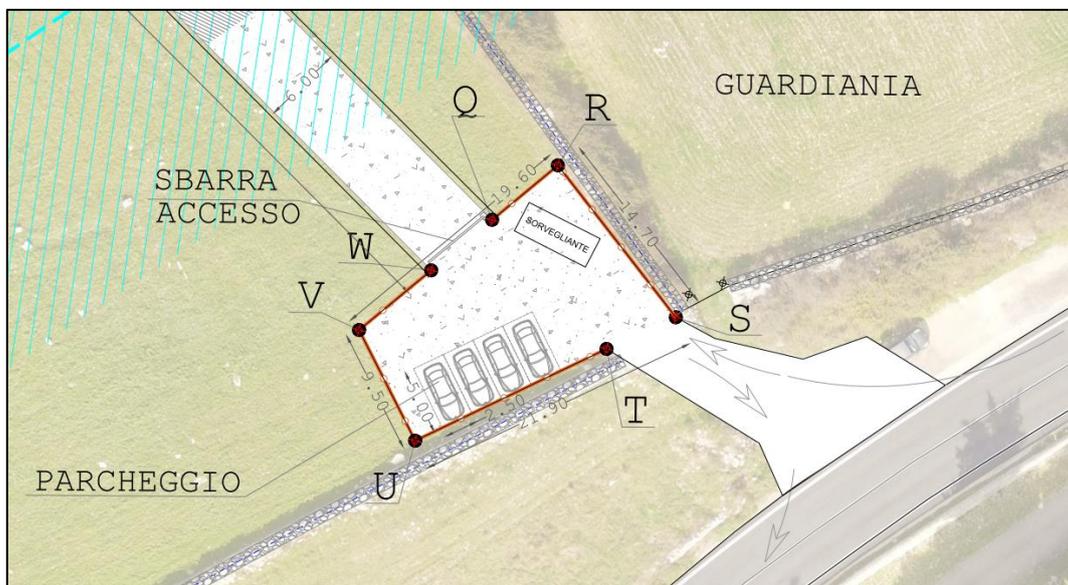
Area ingresso dalla S.P. 62 e parcheggio
